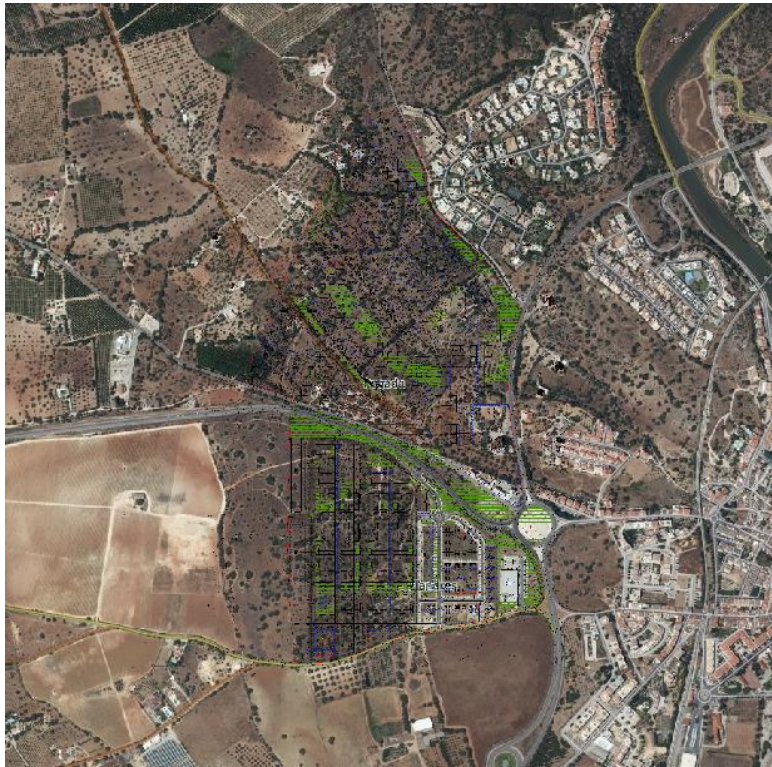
Planta de Implantação do PPPG. Fonte: Geo Portal da Câmara Municipal de Tavira
